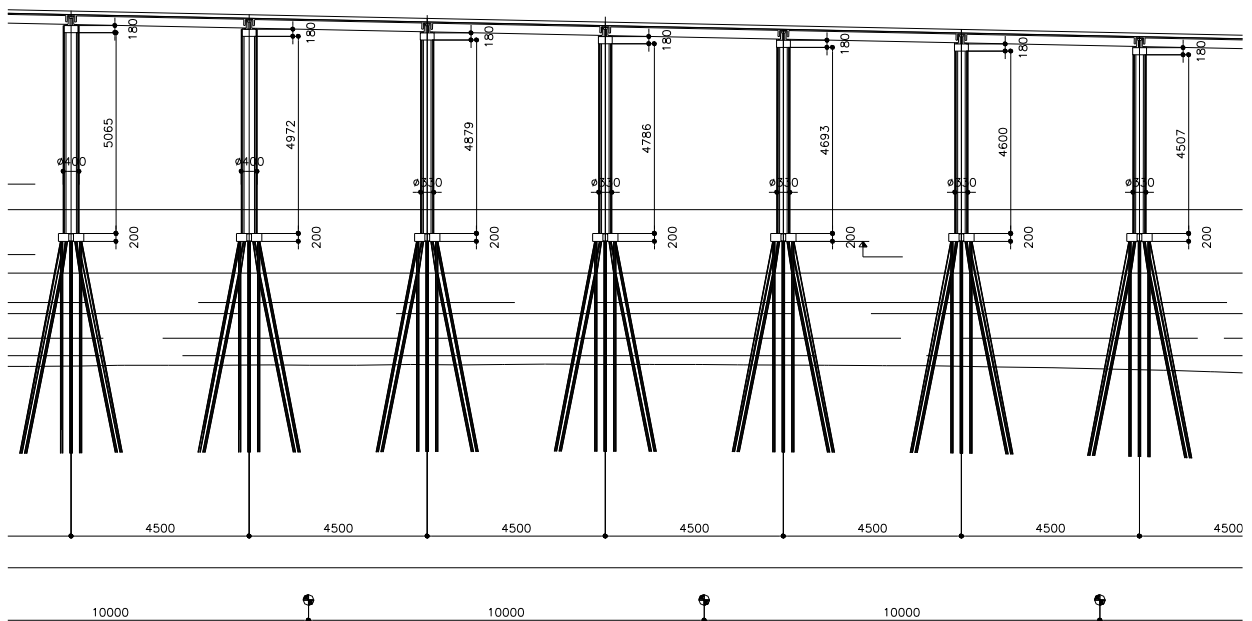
Perfil Longitudinal da Ponte (trecho de pilares)
